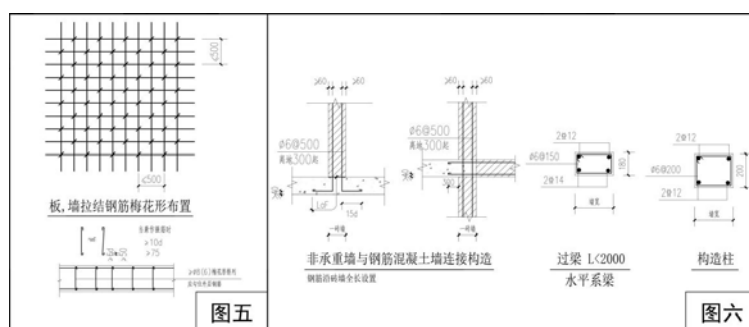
：拉结筋布置示意图      图 6：砖墙与混凝土墙的连接构造、门洞过梁及构造柱配筋
